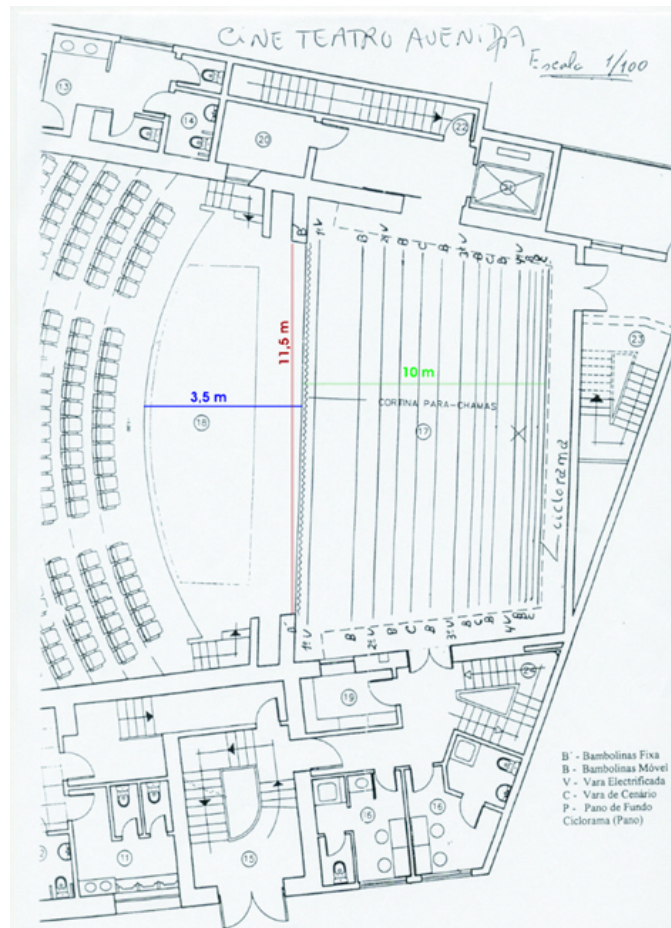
Planta palco Cine-Teatro Avenida<sup>6</sup>
